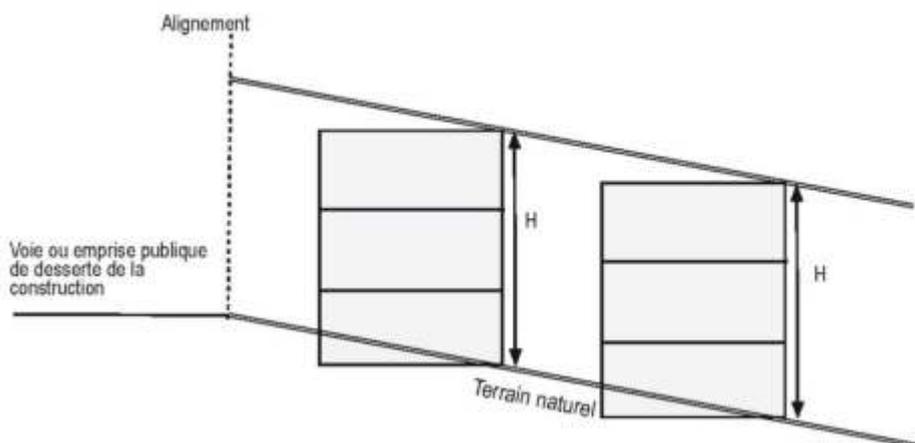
illustrations de la mesure de hauteur maximale de la construction par rapport au terrain naturel (TN) sur terrains en pente
